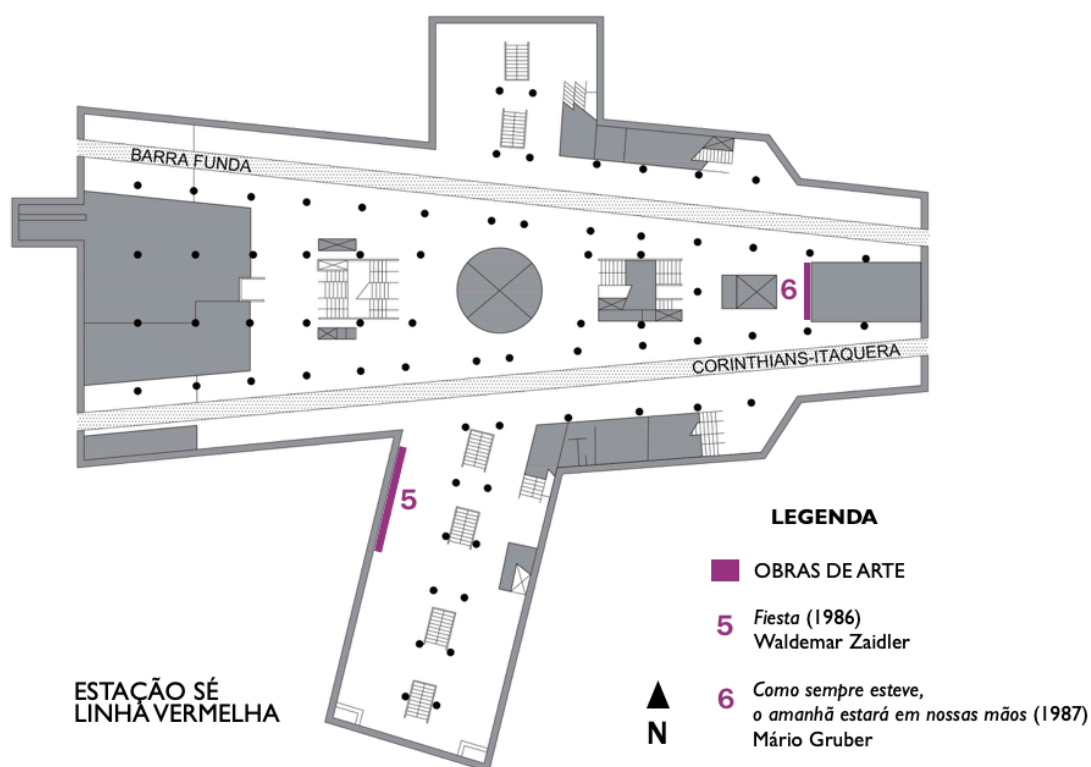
Pavimento da Linha Vermelha, abaixo do mezanino, disposição das obras de arte
